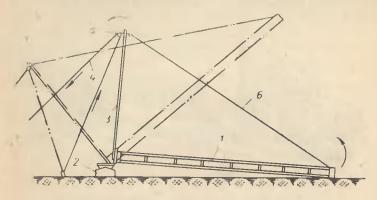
Схема установки опоры падающей стрелой. 1— опора; 2— фундамент: 3— падающая стрела; 4— трос лебедки; 5— ролик; 6— трос.
